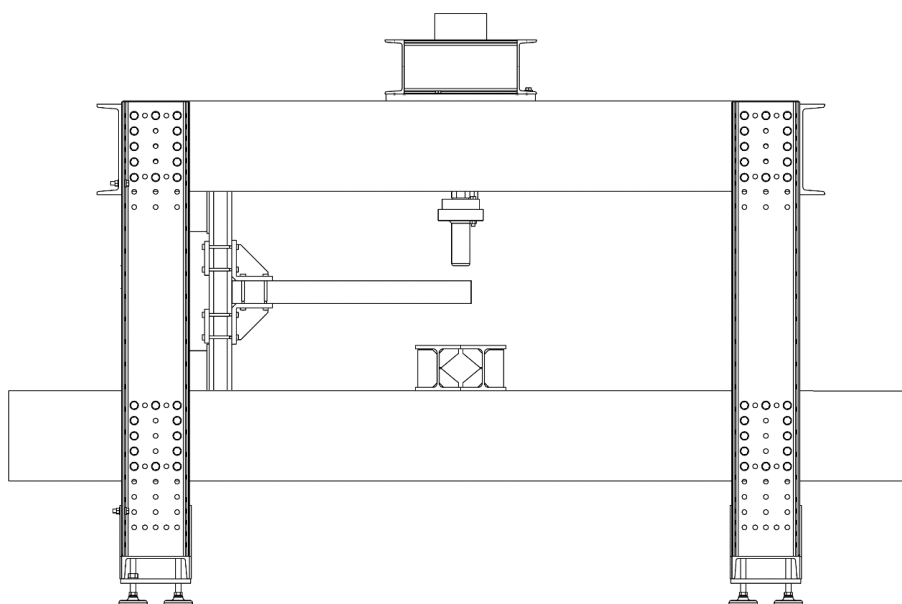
Plano de alzado de la prensa de 300kN de ensayos estáticos del laboratorio de estructuras de la Universidad de Vigo, con la unión a ensayar de tubos unidos con bridas a 90°.
